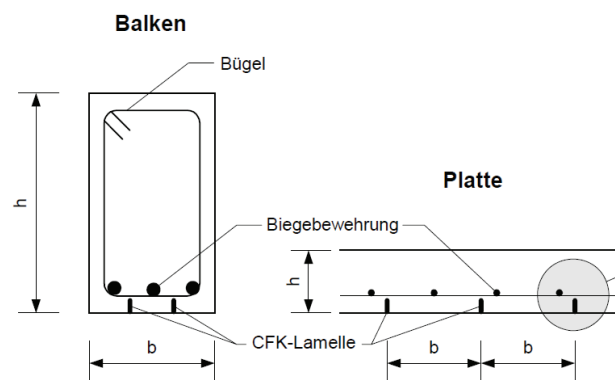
Eingeschlitzte CFK-Lamelle bei typischen Querschnitten (MIHALA, 2008)
